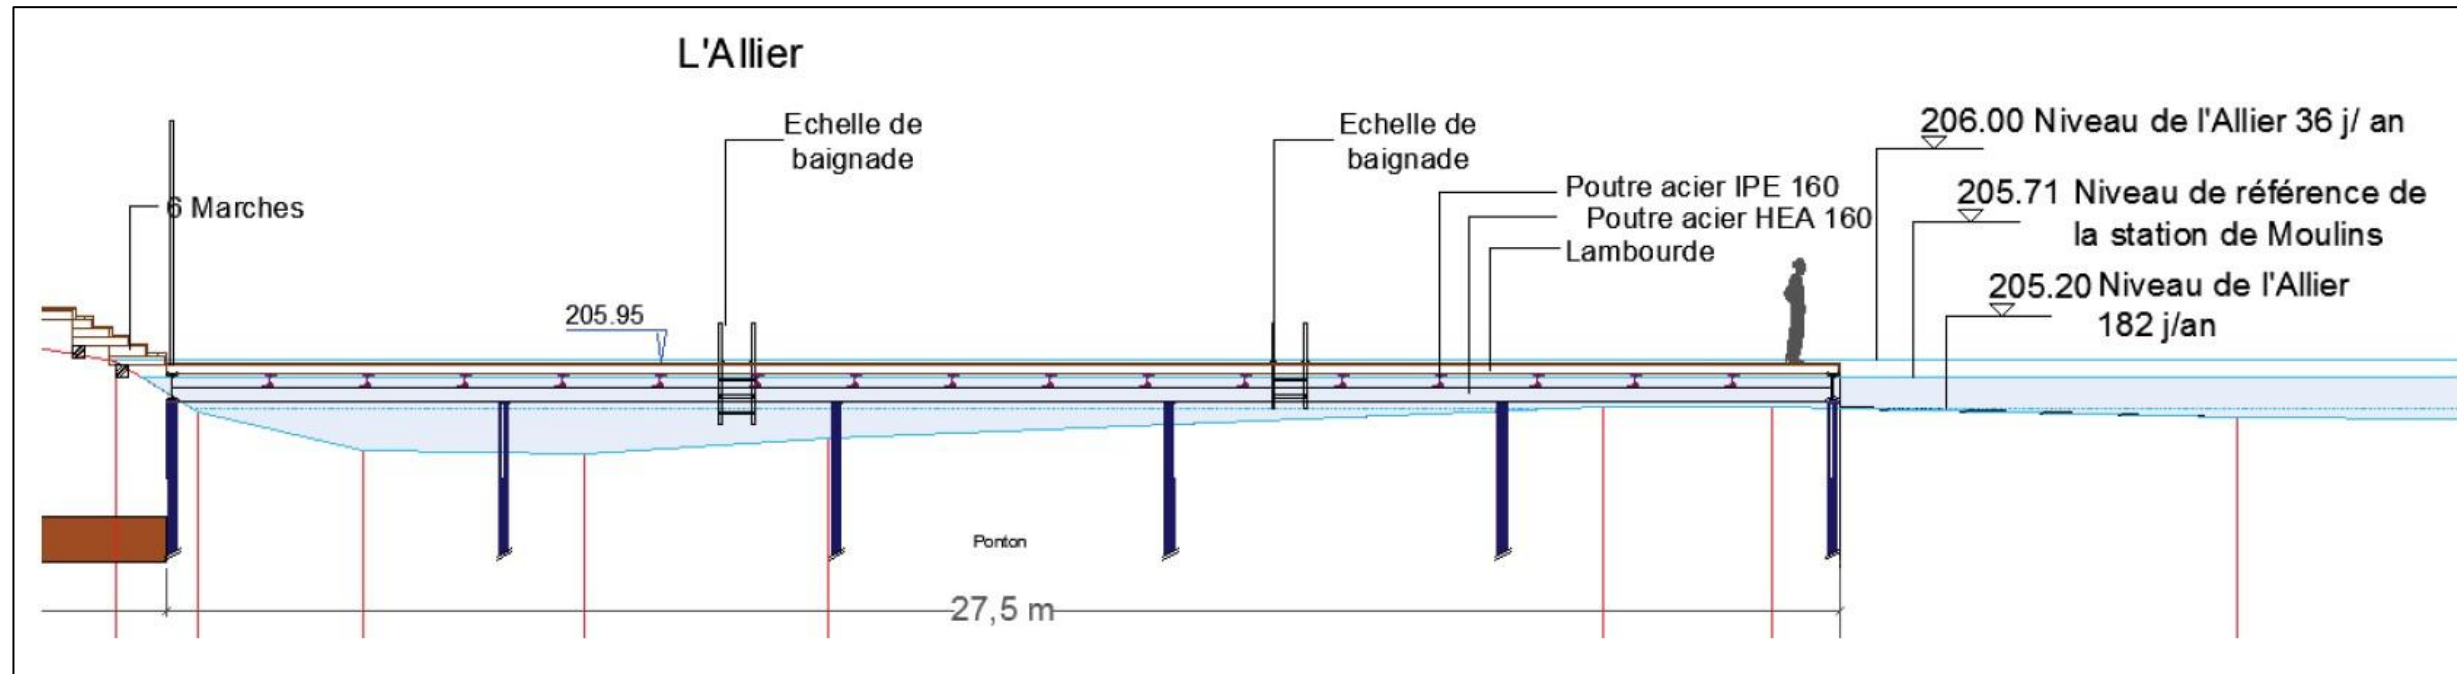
Coupe longitudinale de la jetée du maxi ponton
